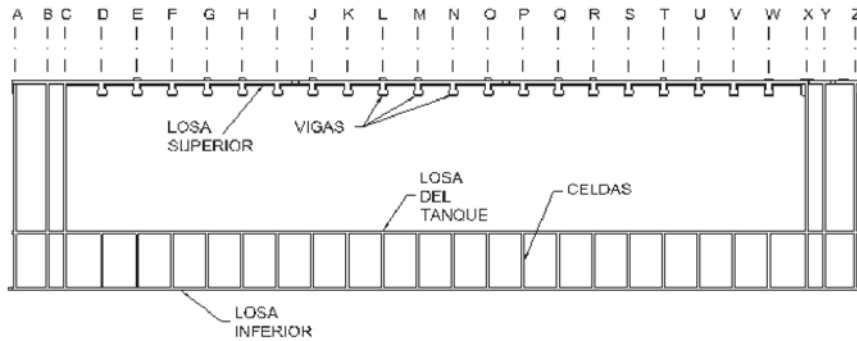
Sección longitudinal del GBS en el que se aprecia el detalle de las vigas postesadas.
